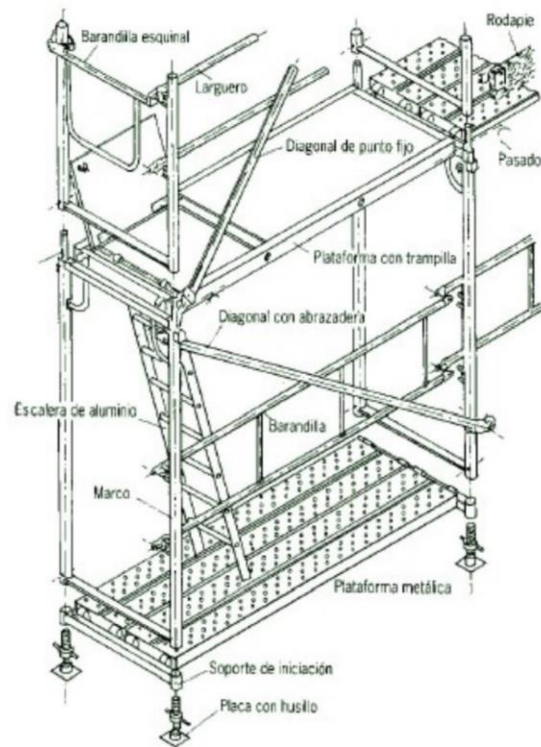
Partes de un andamio fijo prefabricado sistema modular
